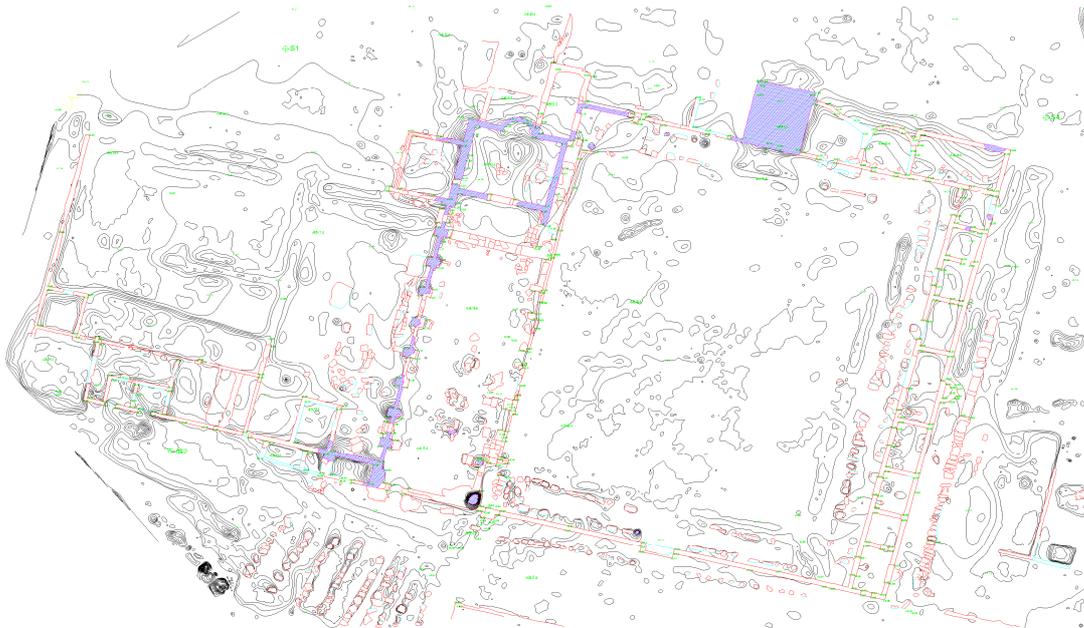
Dettaglio della pianta generale, zona del foro (scala 1:200).
